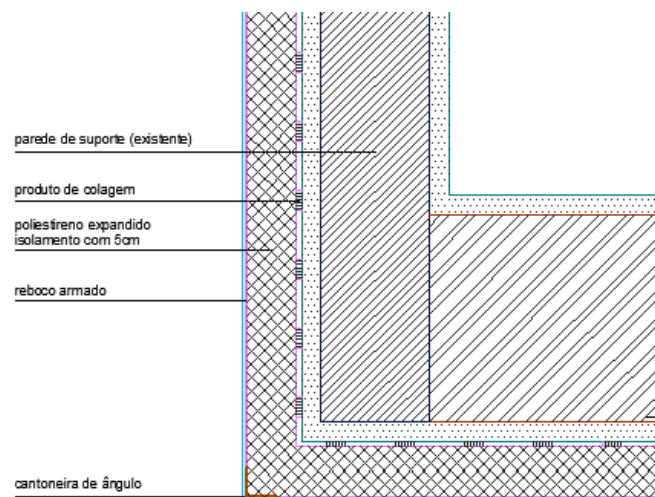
corte horizontal cunhais [peças desenhadas de projeto]
